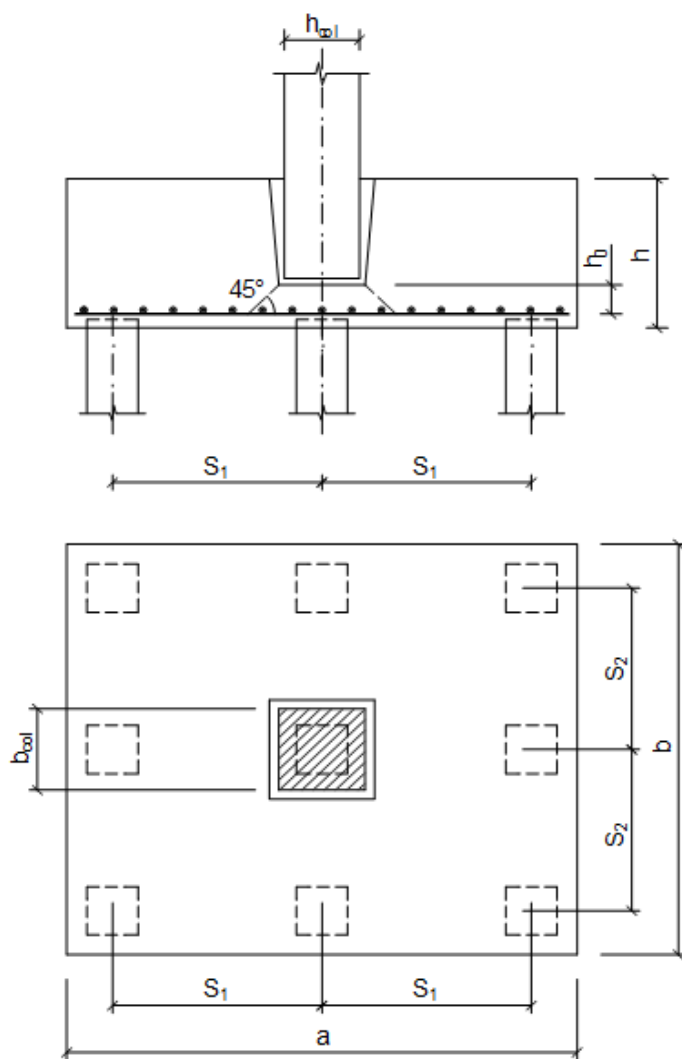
Схема пальового фундаменту з плитним ростверком
